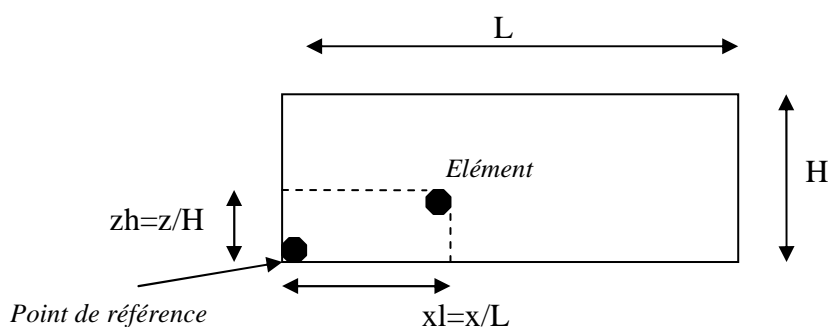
Positionnement d'un élément sur une façade [ALLARD & AL., 1998]
